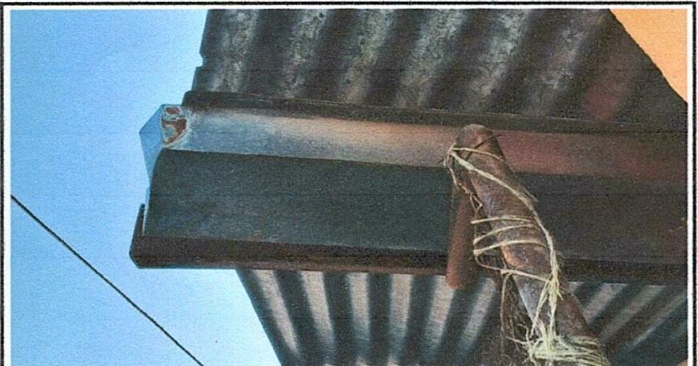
Sustitución de bajada de agua pluvial de metal por tubo PVC 3".
